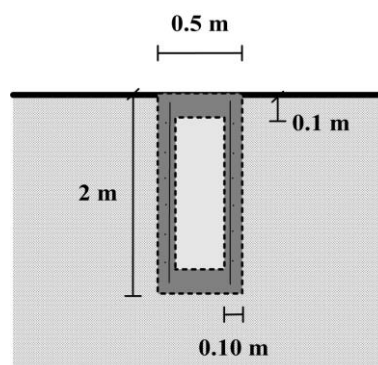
Sección módulo hueco. Fuente: Elaboración propia
